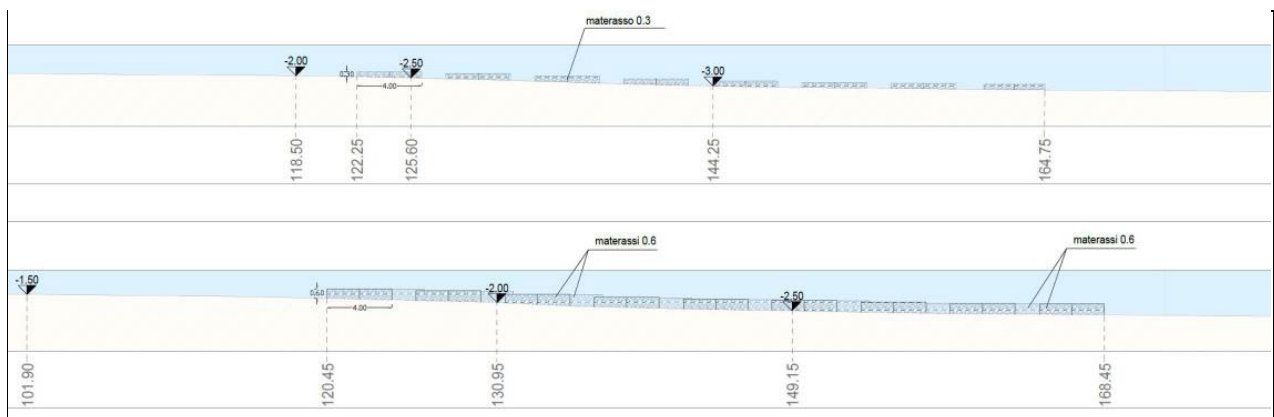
Sezioni di progetto trasversali dell'opera in funzione dell'andamento batimetrico del fondale marino
